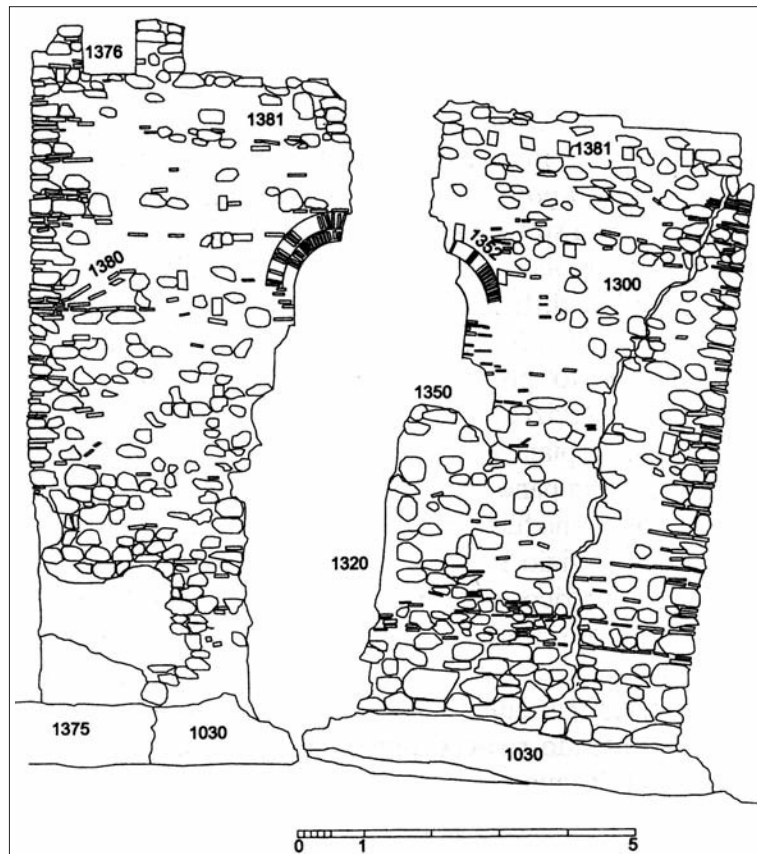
Area 1000. *Donjon* prospetto esterno del muro 1300
